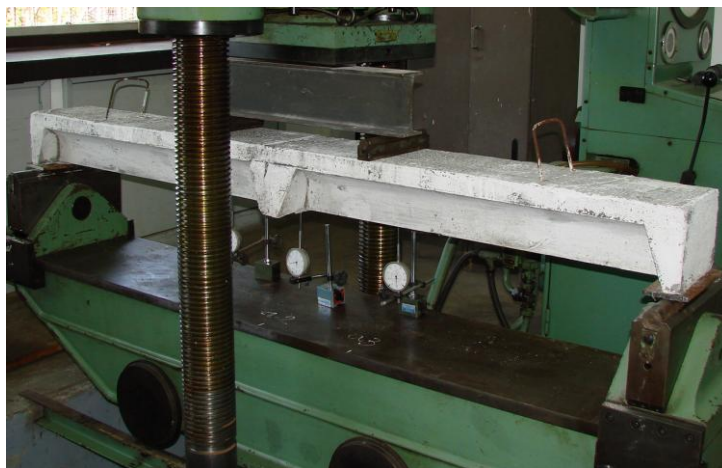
Aspecto da Viga V-1 posicionada para o ensaio
